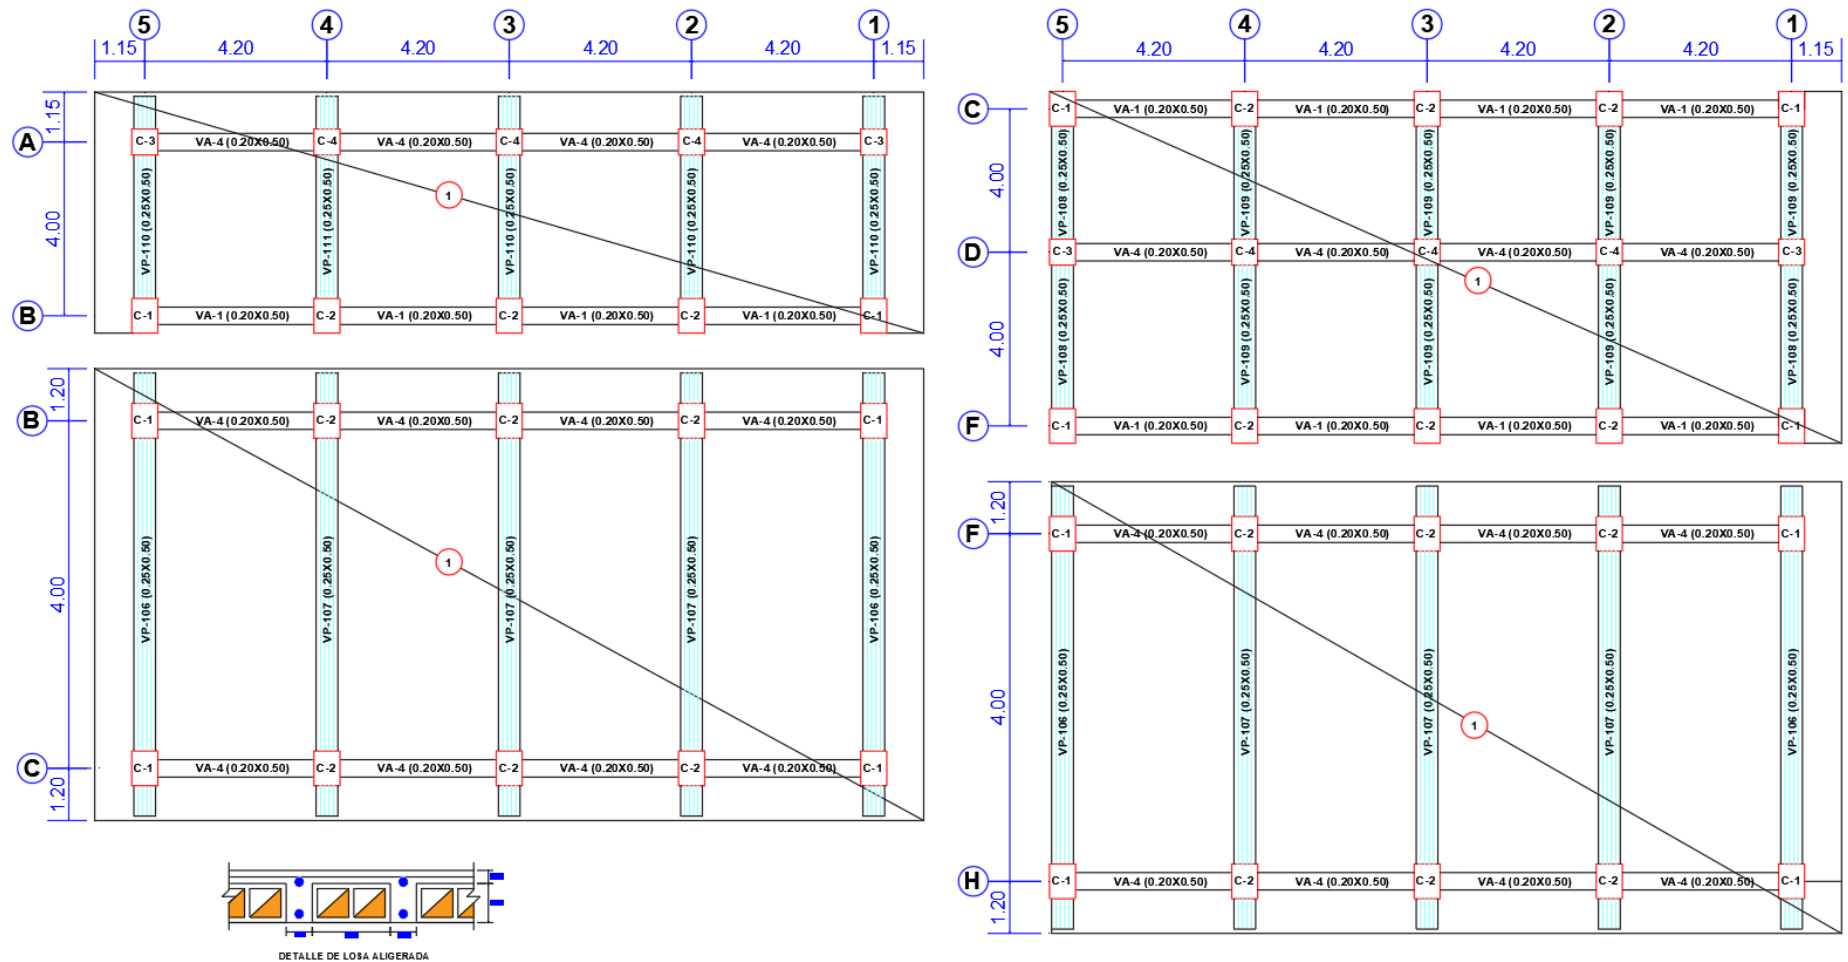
Distribucion de los elementos estructurales del Segundo Nivel (Fuente: Archivos del Área de Archivo Central, de las obras ejecutadas en la Universidad Nacional de San Martín – Tarapoto)
